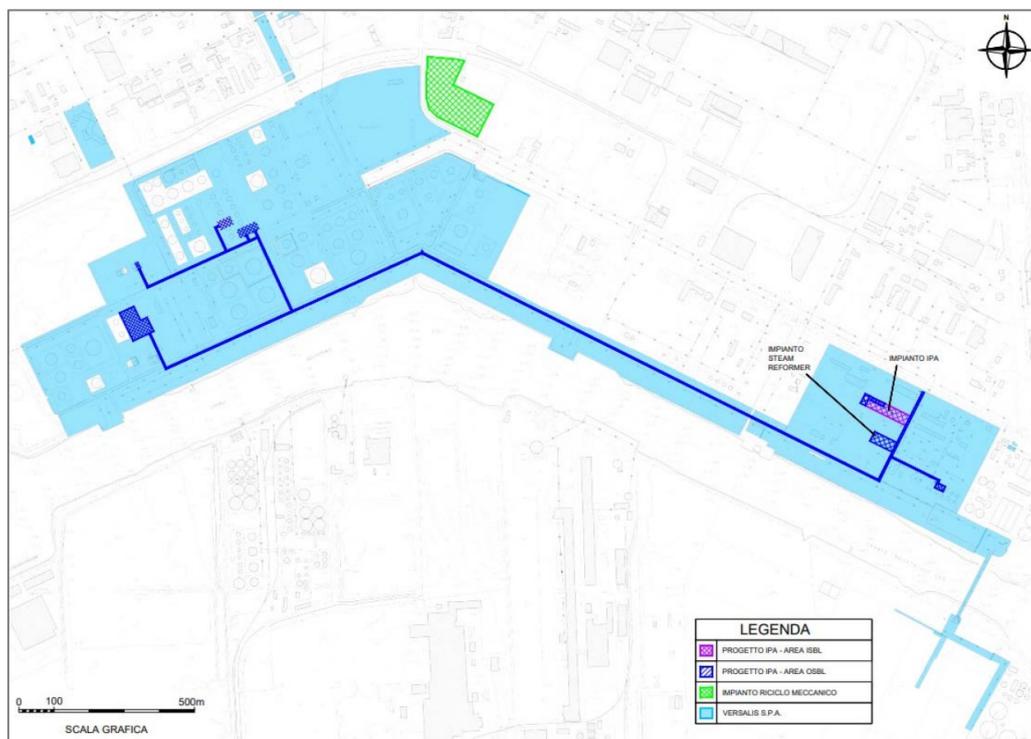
Planimetria con evidenza delle aree interessate dal progetto in esame
